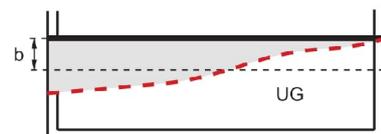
Auszug Figur 6.2 Untergeschosse, IVHB Kanton Zug, Anhang 2 Skizzen, BGS 721.7-A2
